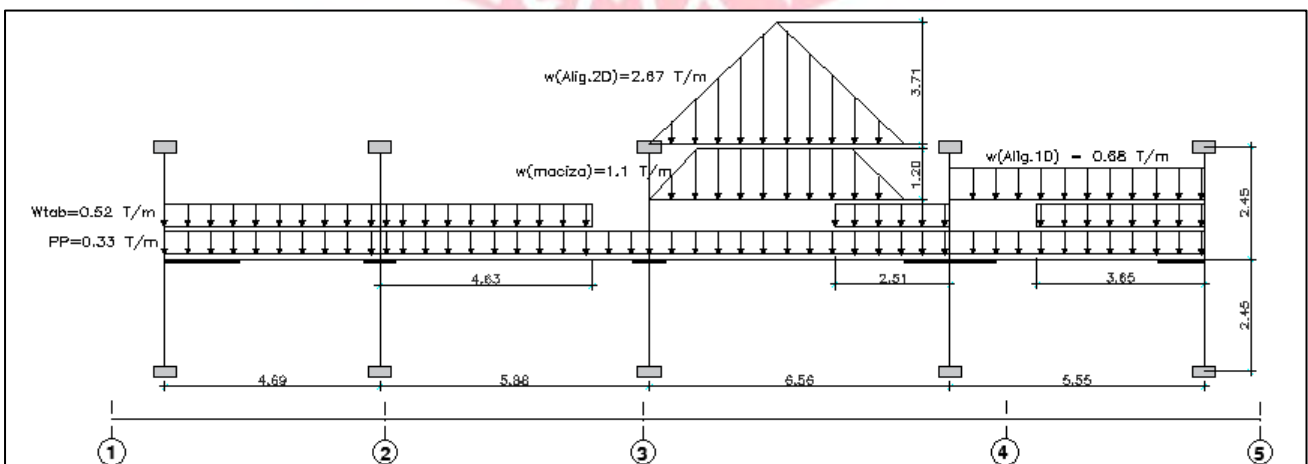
Metrado de carga muerta en viga VT- 6.
